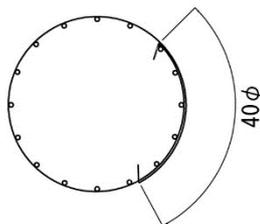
帯鉄筋の継手の例 (鋭角フックの場合)
